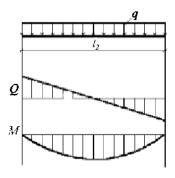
Расчетная схема балки настила (однопролетная разрезная балка)
